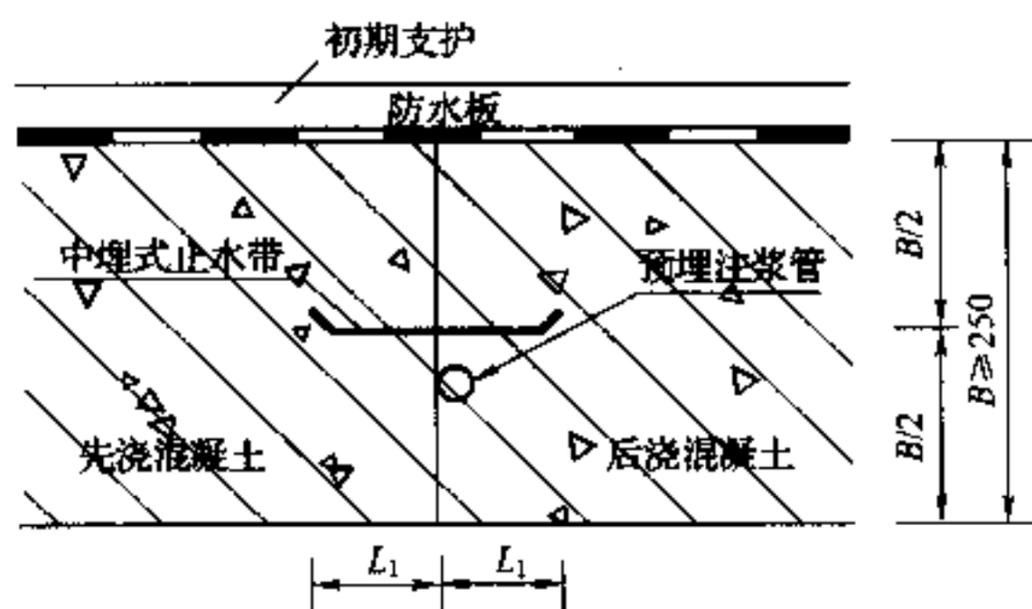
4 中埋式止水带和预埋注浆管的施工缝构造形式 (单位: mm)
